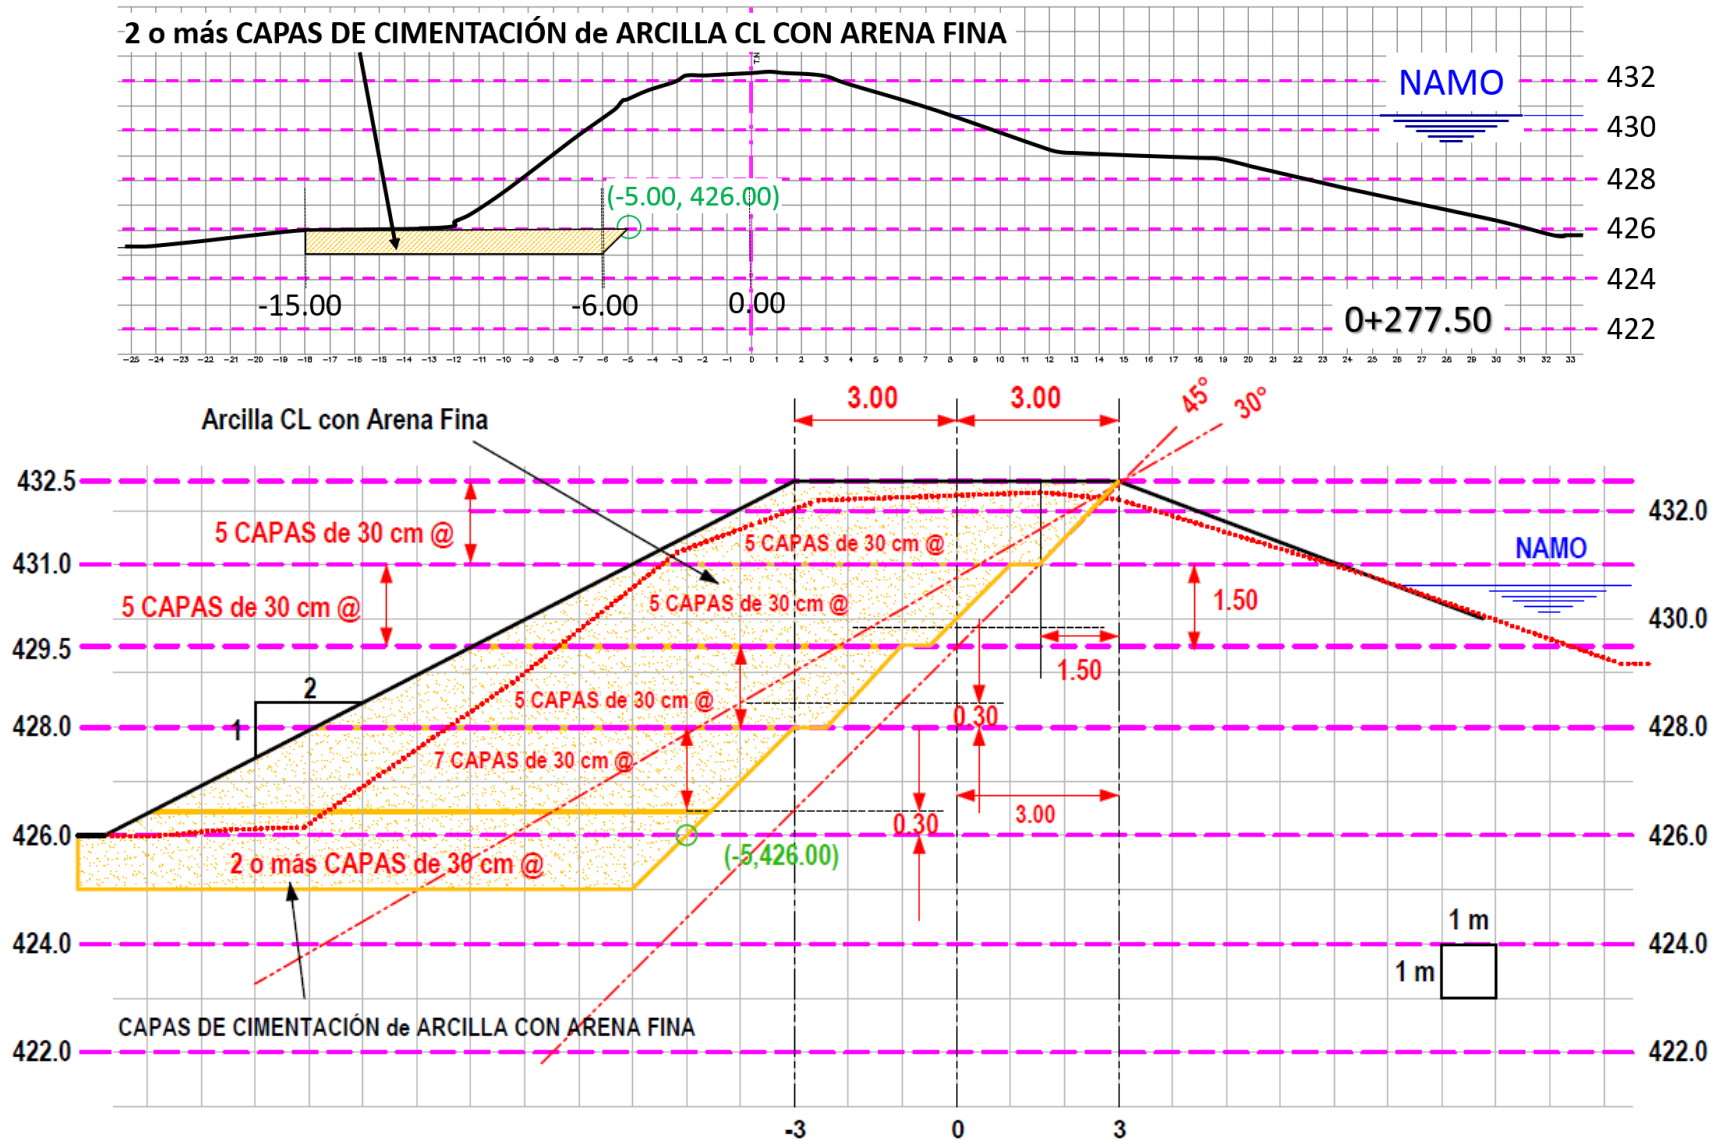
Esquema de reconstrucción de la cortina entre las secciones 0+265 y 0+290.
